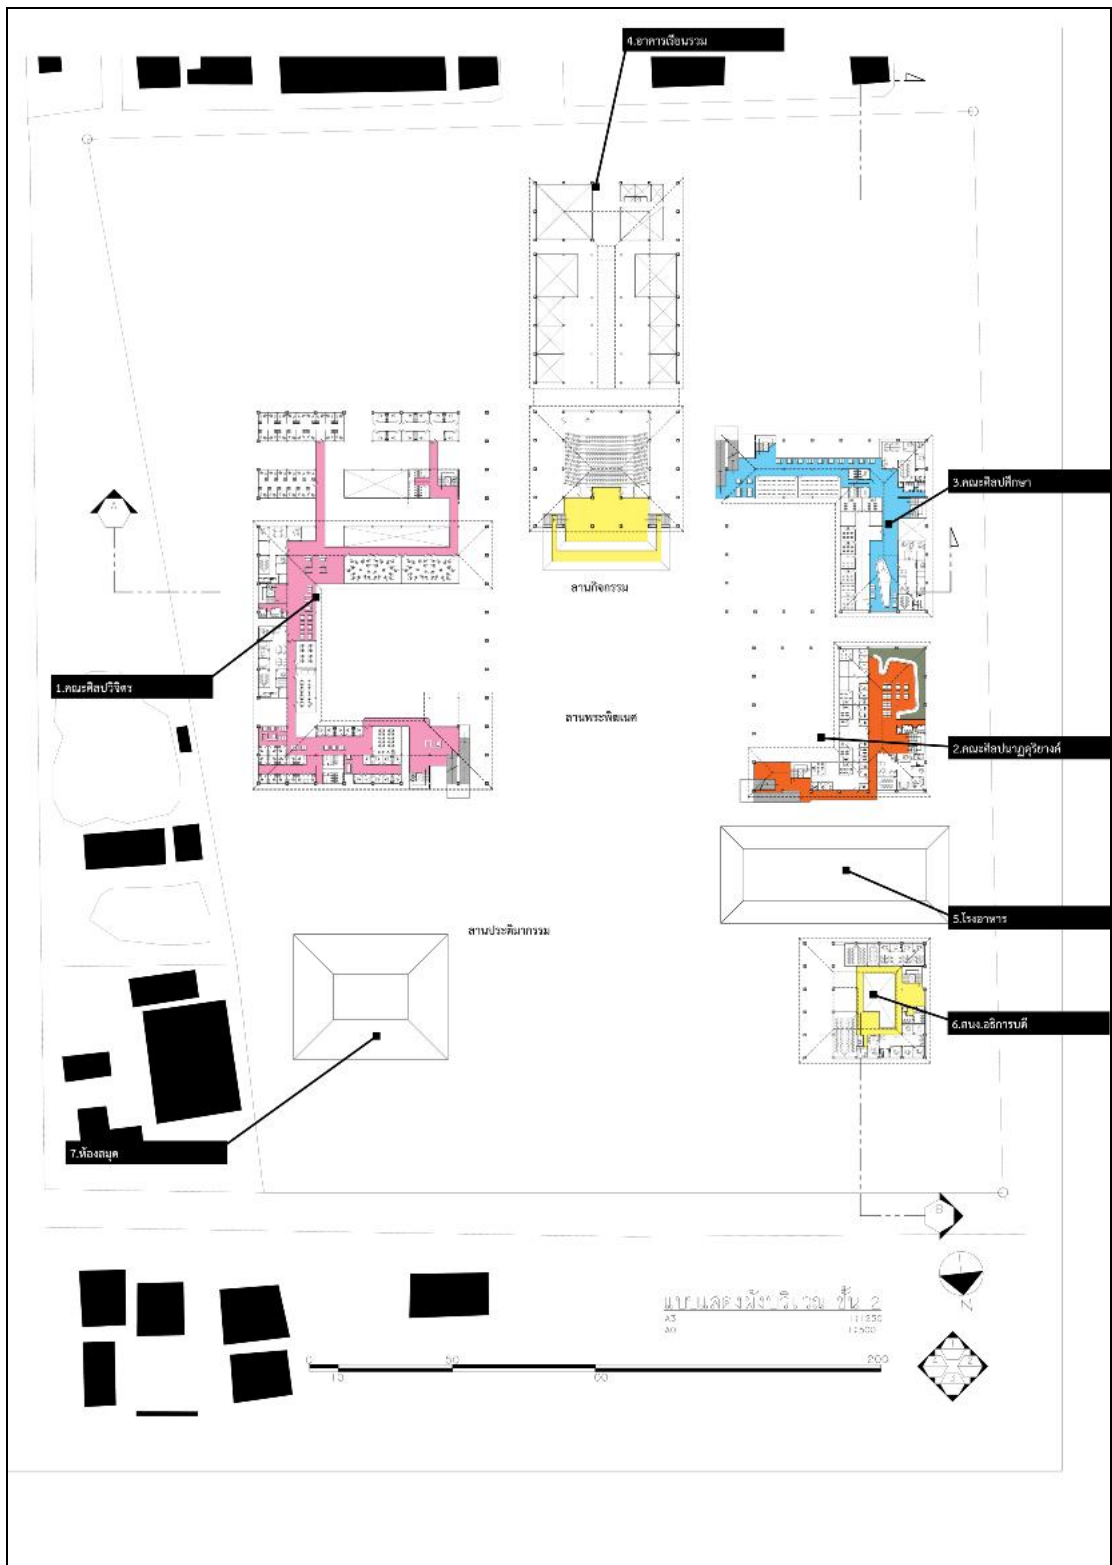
การพัฒนา Site Plan ครั้งที่ 2
